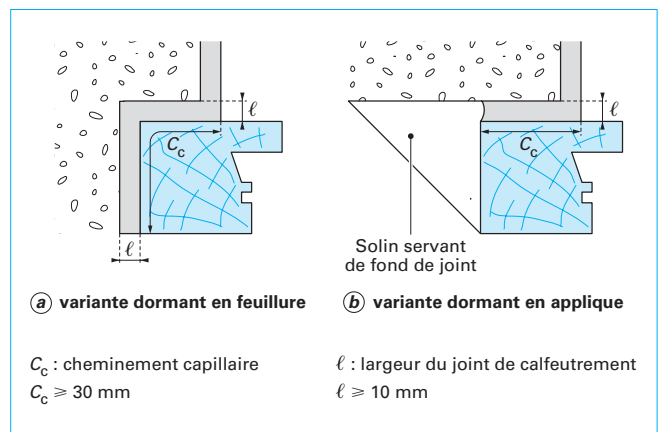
Calfeutrement de mode 1 (sections sur montants ou traverse haute)
